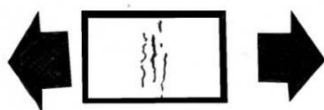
Detalle de fisuras por un esfuerzo a tracción.
